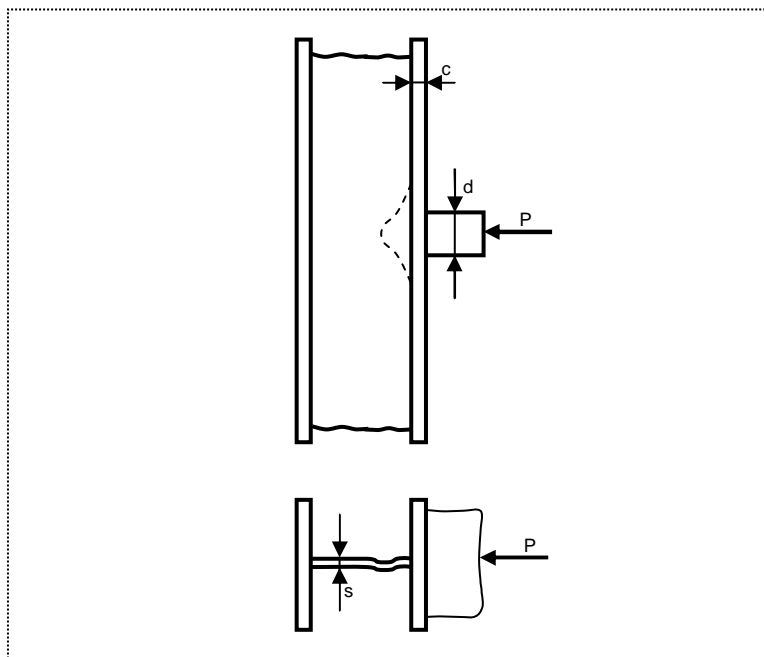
Imbozzamento locale dell'anima dell'elemento di ancoraggio
